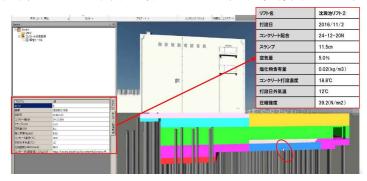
ポンプ場 BIM/CIM モデルへの施工情報の付与の例
